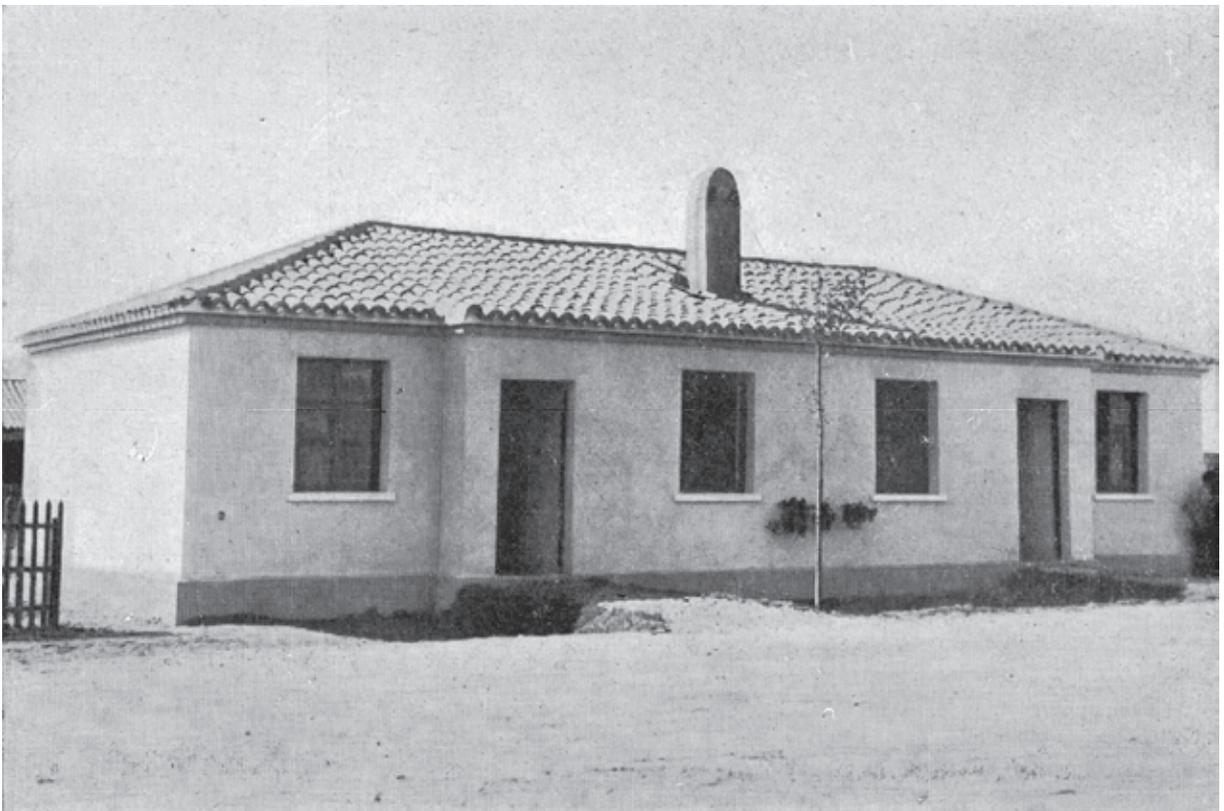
Fotografía de la fachada a la calle de dos casas pareadas de tipo 5 de la primera fase de la barriada Yagüe, 1945. Fuente: Servicio Militar de Construcciones, 1946, s.p.
